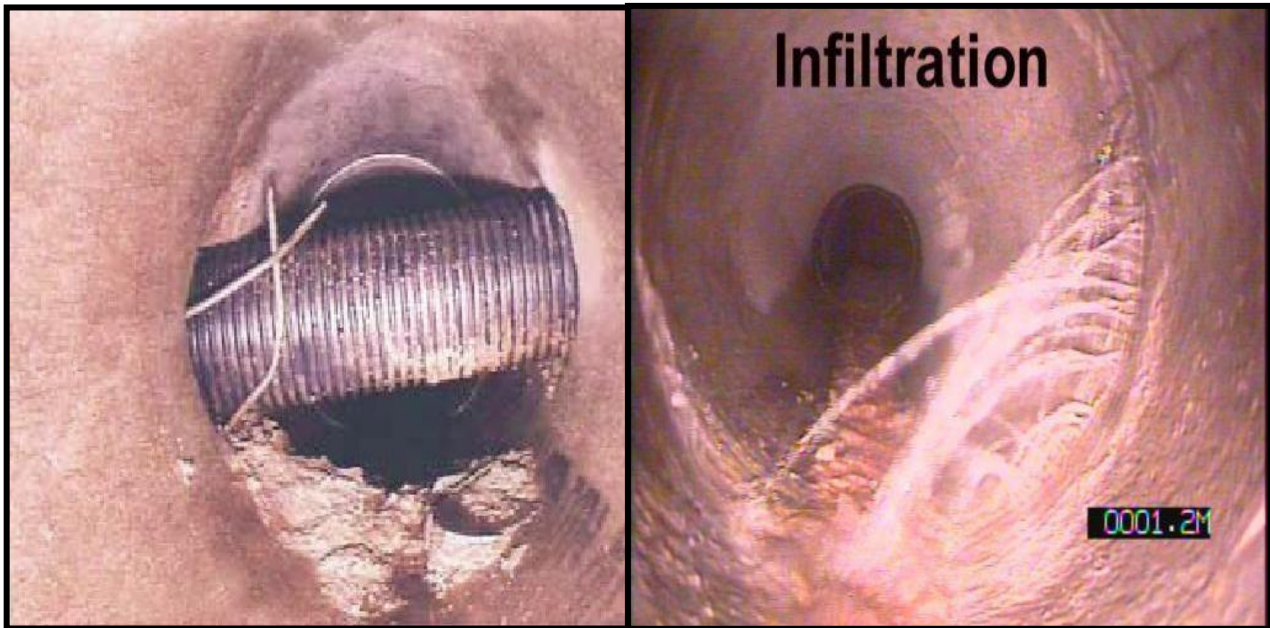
Daños estructurales y operacionales de las redes de alcantarillado según inspecciones con CCTV EAAB 2011
